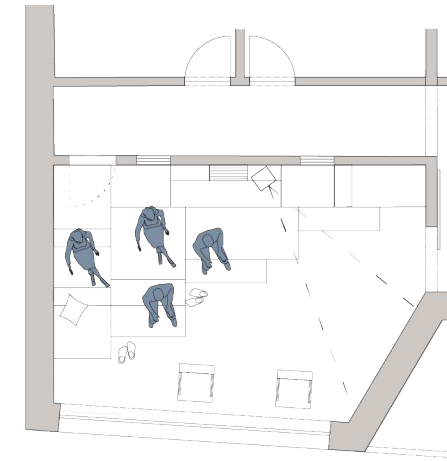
Grundrissvariante 1 - Gemeinsame Filmabend
